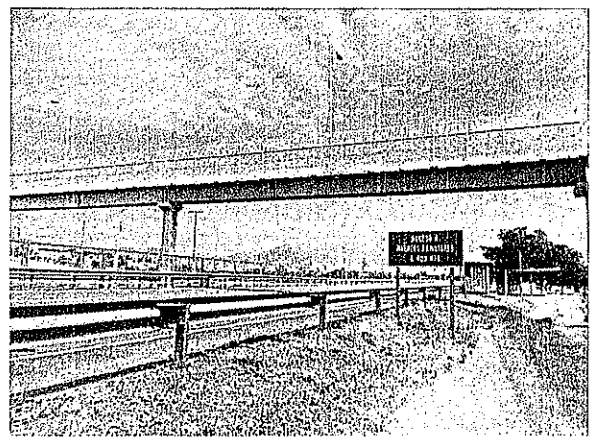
Km. 38.3 Pasarela Huertos Familiares, cambio de vigas centrales, soldadura es el vínculo entre losa de hormigón y viga metálica, existen desniveles en pavimento de circulación.
